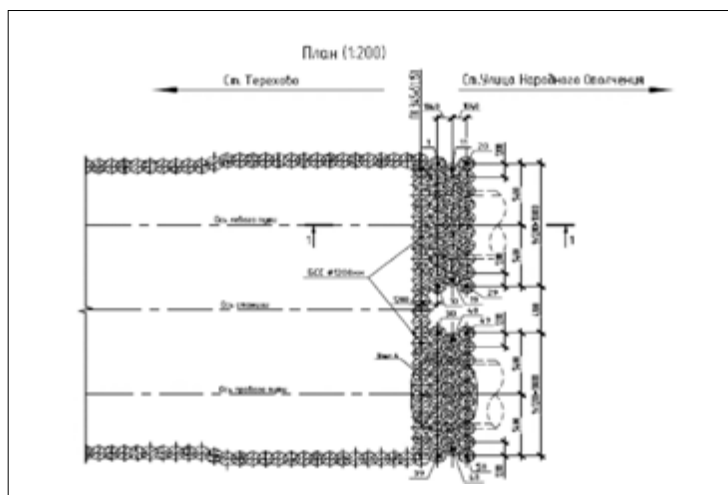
План ограждения котлована и пригруза, выполненные из БСС
